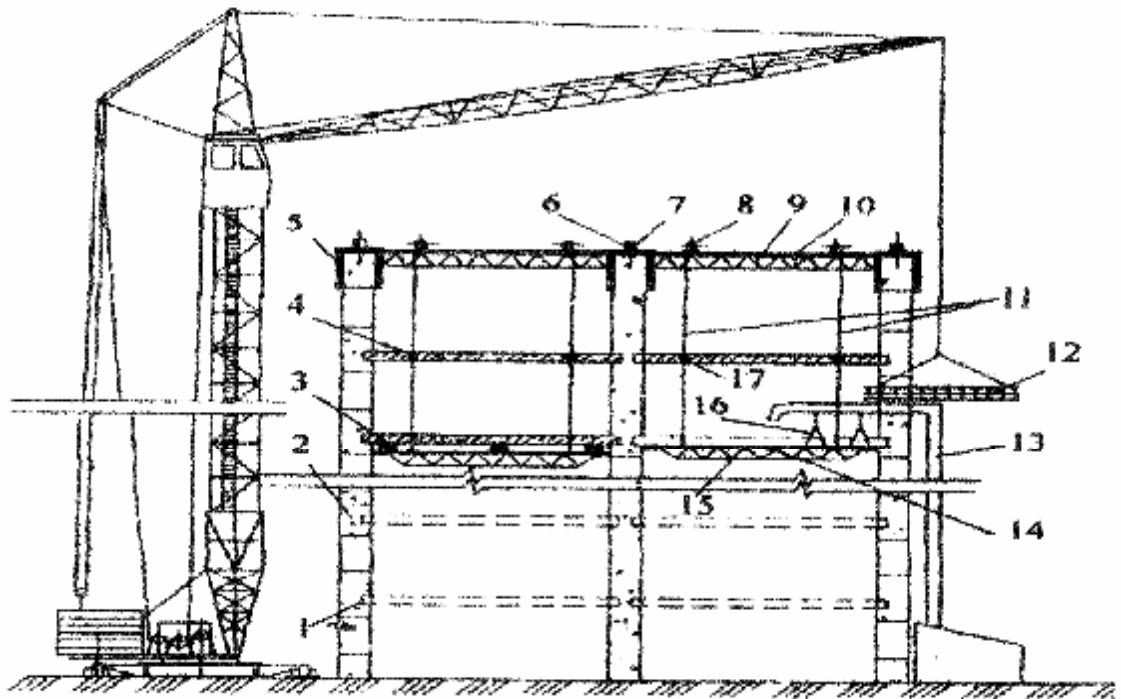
Бетонування міжповерхових перекриттів методом "зверху вниз": 1 – штраби; 2 – стіна; 3 – пневматичне відбивне пристосування; 4 – монолітне перекриття; 5 – домкратна рама; 6 – домкратний стрижень; 7 – гідродомкрат; 8 – гальмівні пристрої; 9 – опалубочний щит; 10 – робочий стіл; 11 – гнучкі тяги; 12 – армокаркас; 13 – бетоновод; 14 – опалубка перекриття; 15 – несуча ферма опалубки перекриття; 16 – стійка; 17 – гільза
